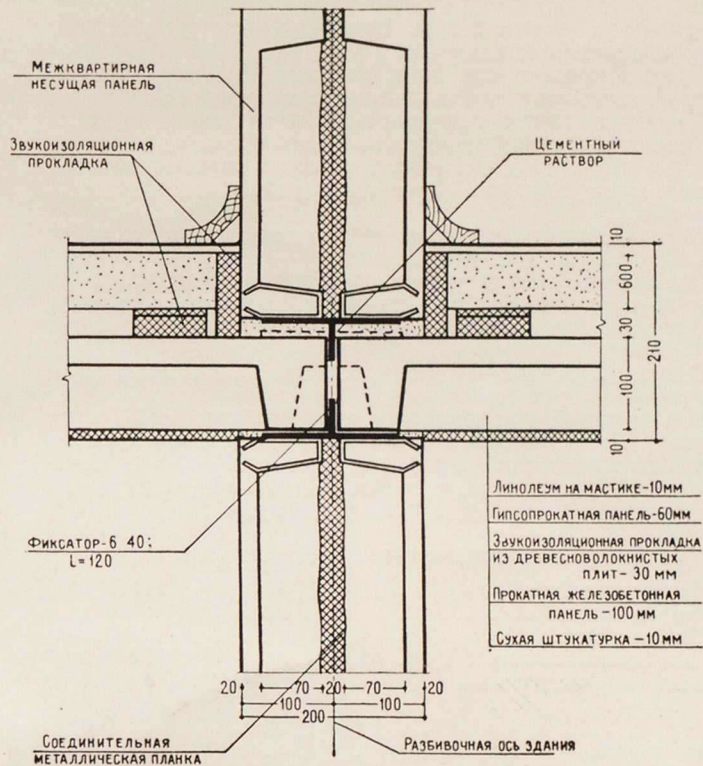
Сопряжение панелей внутренней несущей стены и панелей перекрытия
